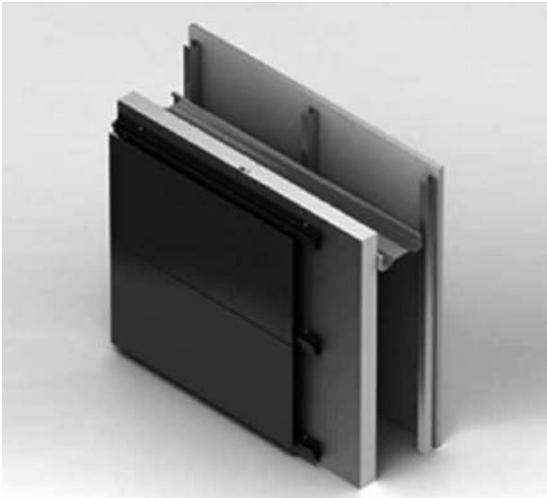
Perspectiva esquemática de uma vedação externa utilizando painéis metálicos isolantes (BENCHMARK KINGSPAN, 2014)
